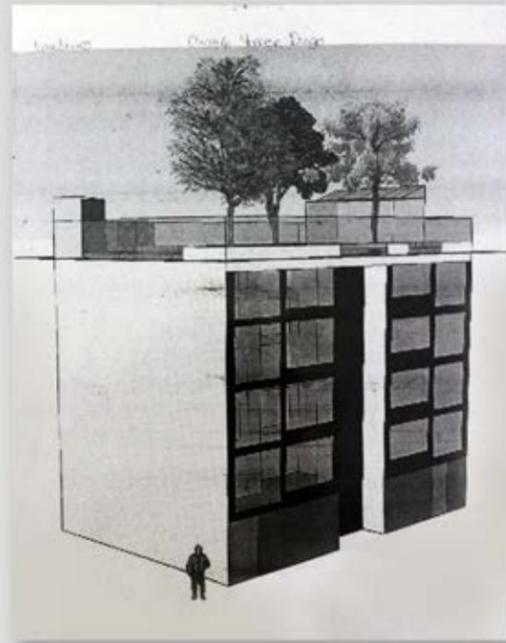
y 5b. Proyecto de innovación. Ejemplo de un plano y la respectiva maqueta de las construcciones con azotea verde.
